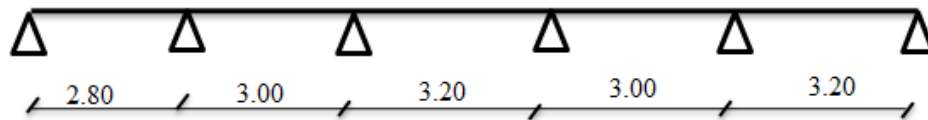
Poutrelle type 02 (Plancher terrasse inaccessible)
